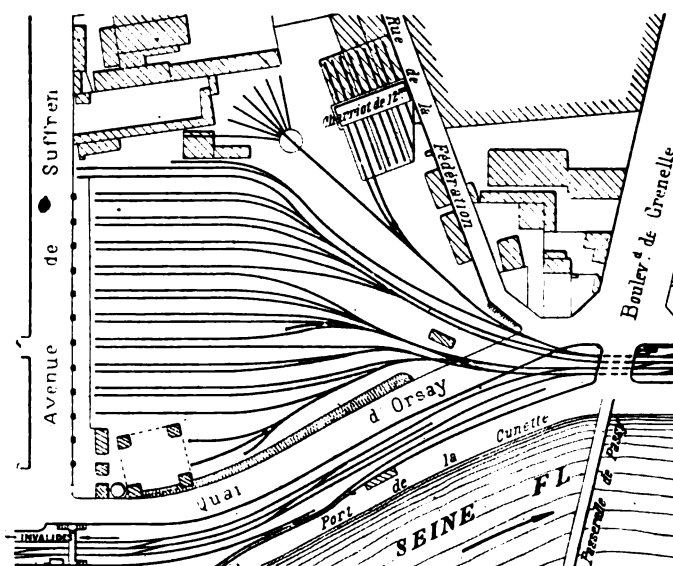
Plan d'ensemble de la station du Champ-de-Mars.
